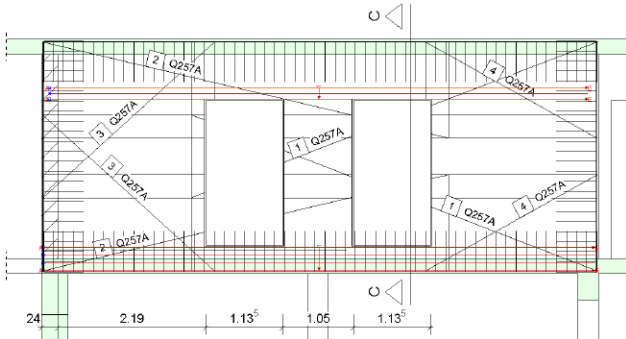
Angepasste Längsbewehrung über- und unterhalb der Aussparungen
